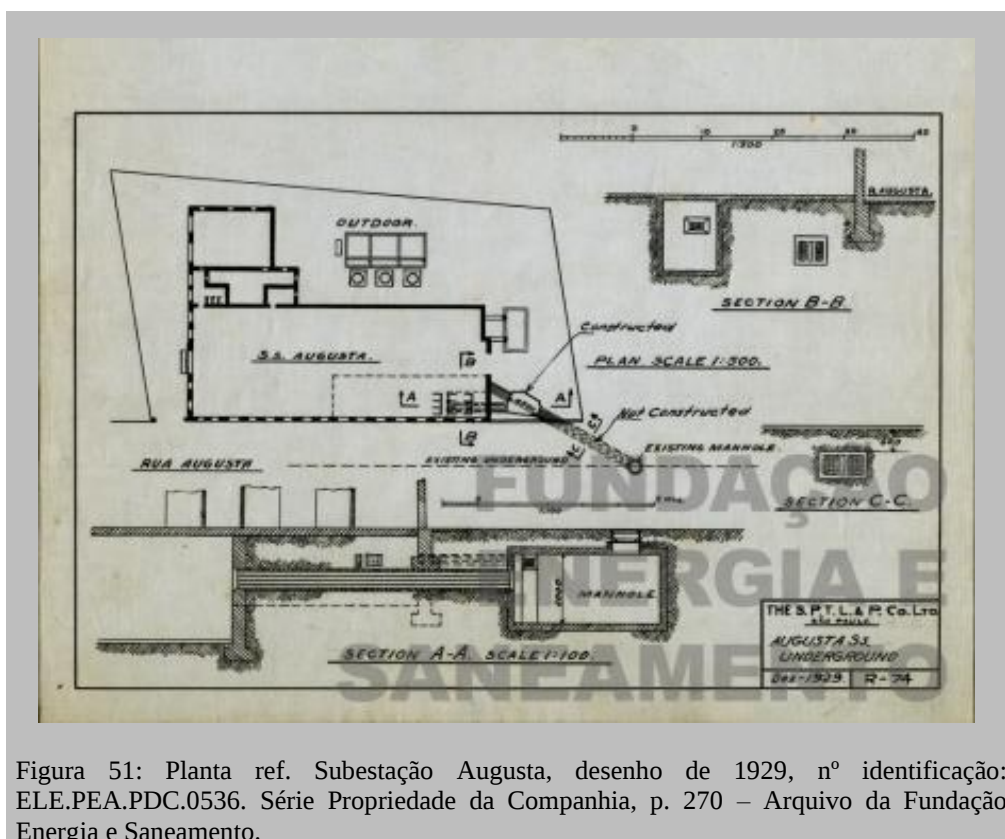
Planta ref. Subestação Augusta, desenho de 1929, nº identificação: ELE.PEA.PDC.0536. Série Propriedade da Companhia, p. 270 – Arquivo da Fundação Energia e Saneamento.
